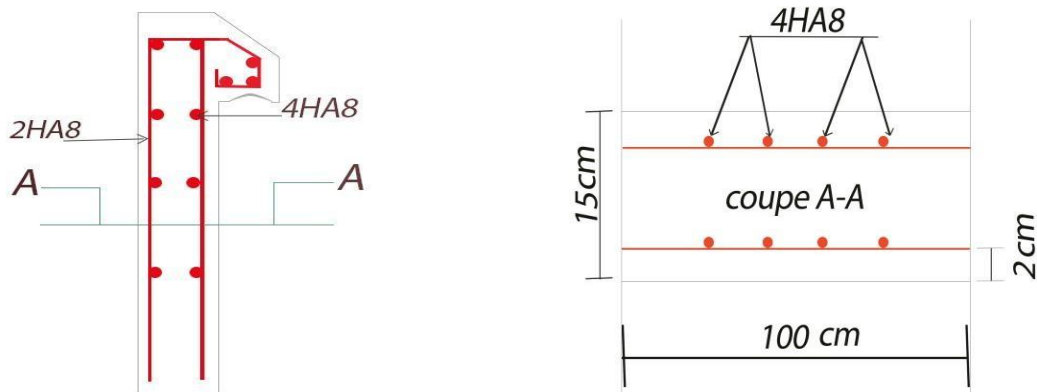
Schéma de ferrailage de l'acrotère.
